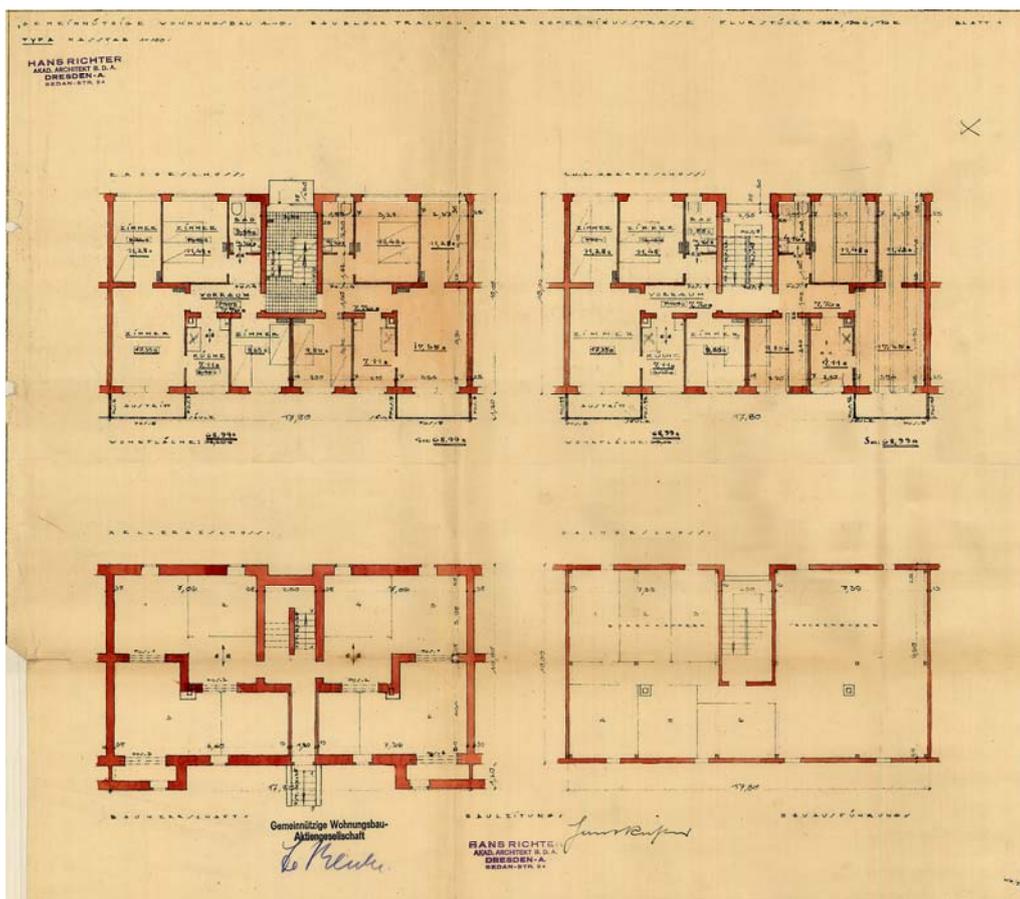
Hans Richter, Grundrisszeichnung Kopernikusstraße, nicht datiert.
